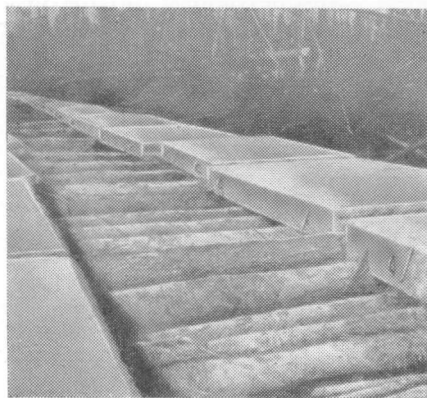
Ус с покрытием из железобетонных плит, уложенных на сплошной поперечный настил
